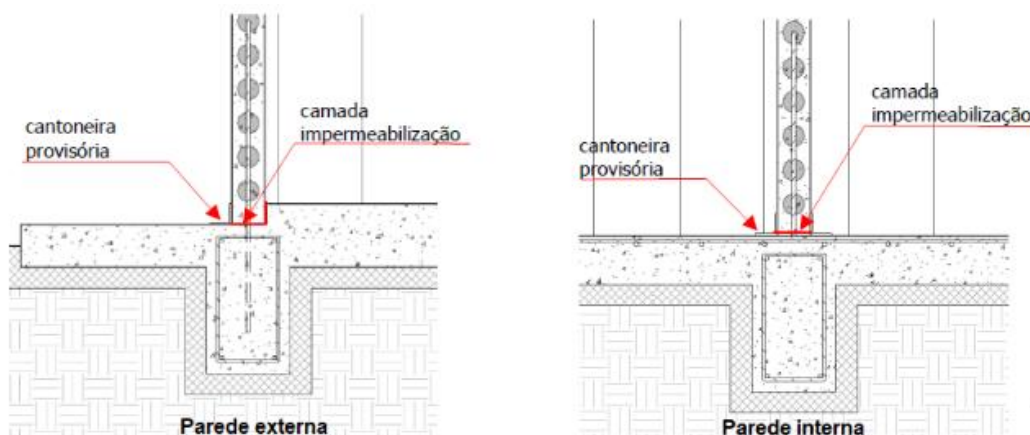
Ilustração da camada de impermeabilização na interface entre paredes e fundação no caso da utilização de guias de piso provisórias em substituição ao perfil “BC 90”. (Sem escala).
